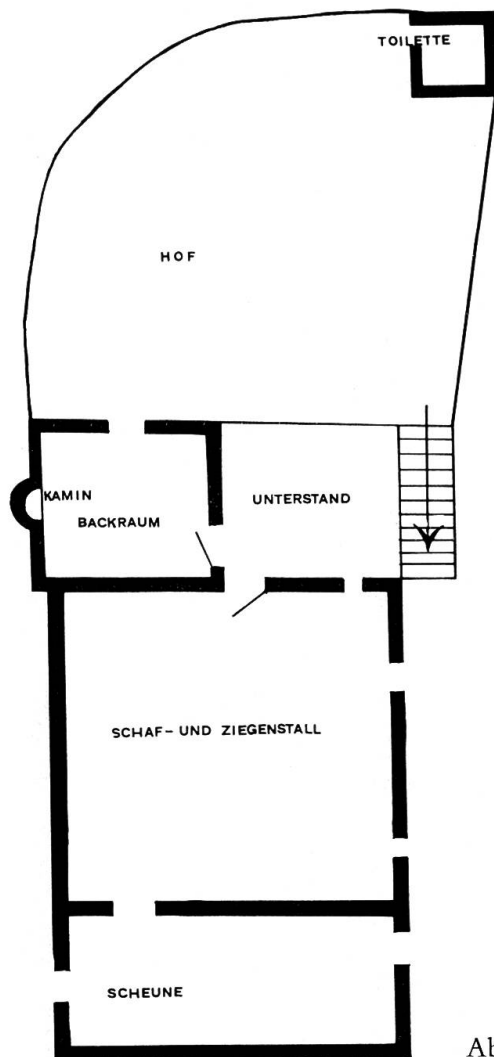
Haus Nr. 88. Erdgeschoß. M 1:400
